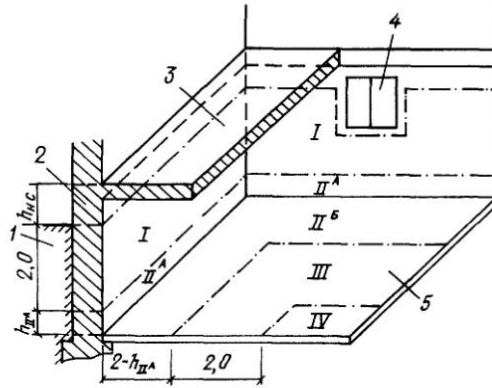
Разбивка заглубленных частей наружных стен и пола углового подвального помещения на I–IV расчетные зоны
